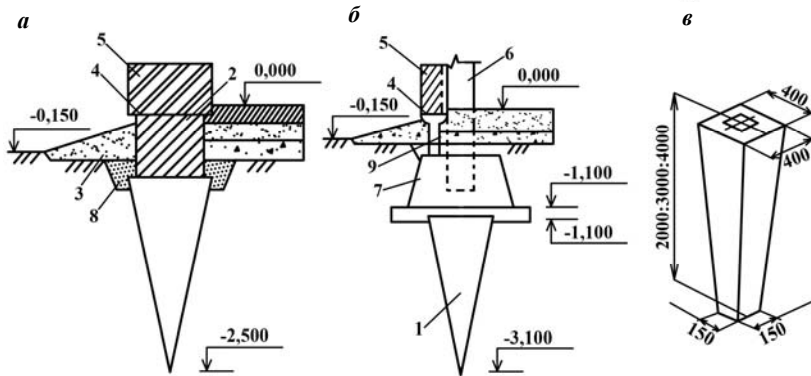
Конструкція фундаменту на коротких пірамідальних палях:
